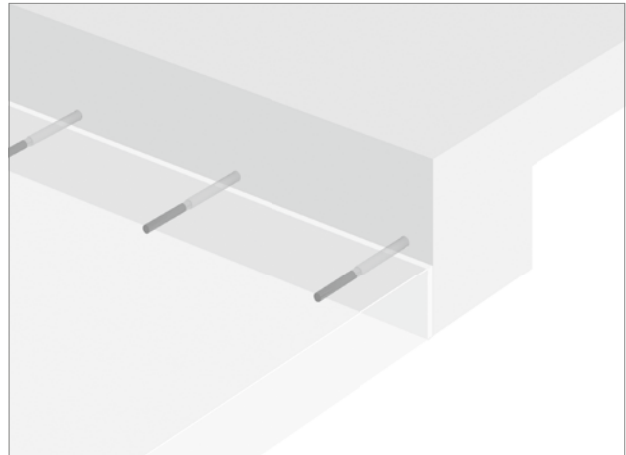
Schöck Stacon® type LD: slab-downstand beam connection
